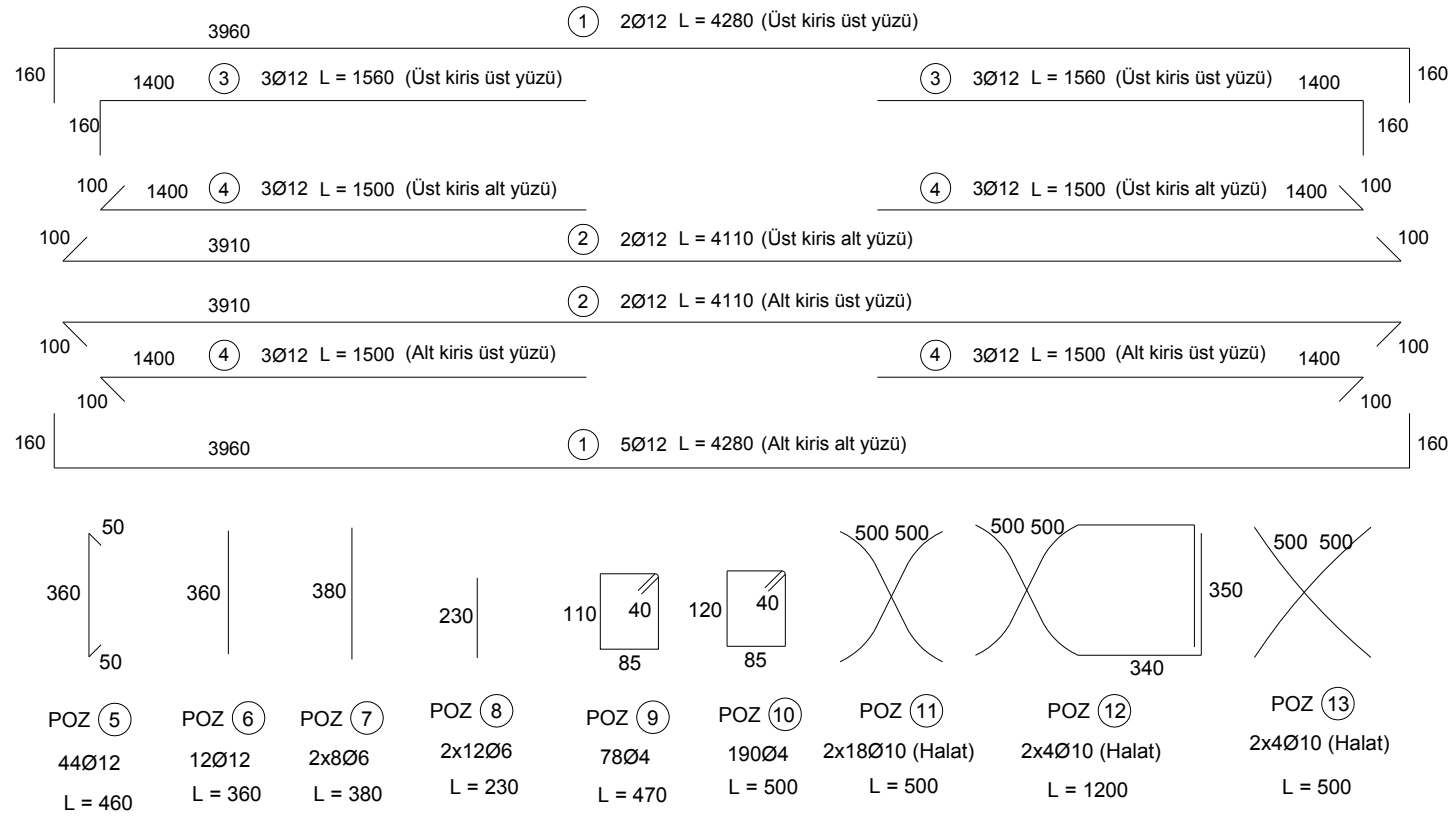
RRxb kiriş donatı planı ve kesitleri
